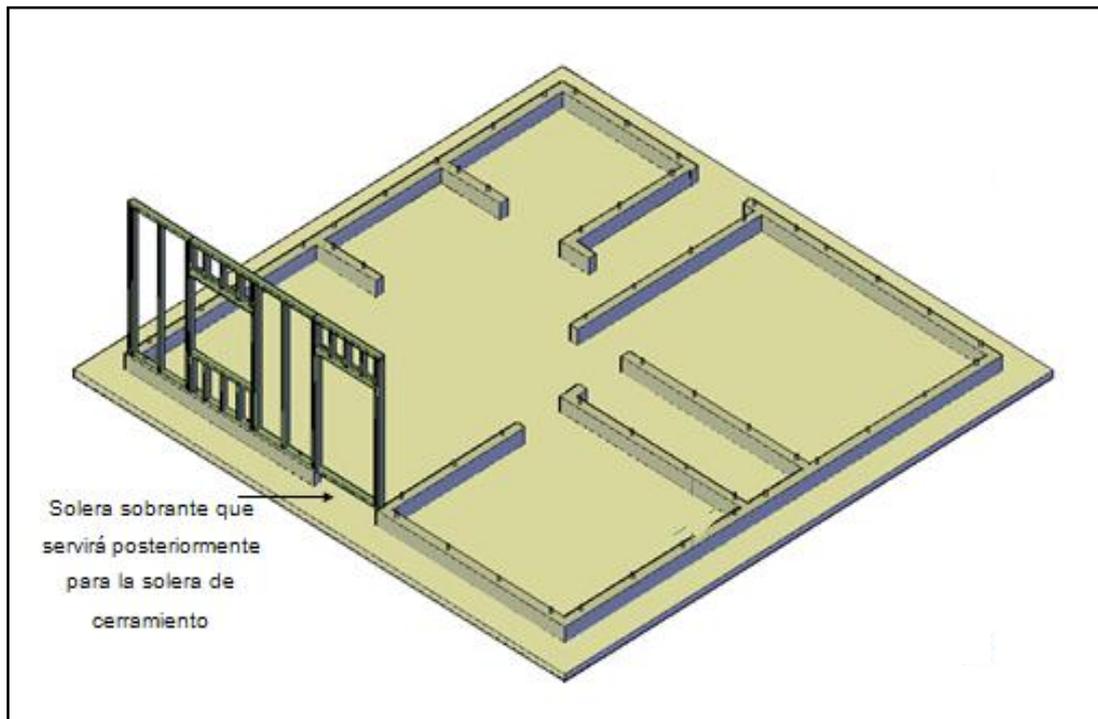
Panel colocado en su sitio de acuerdo a la ubicación del Anexo 1, 8 y 10.
